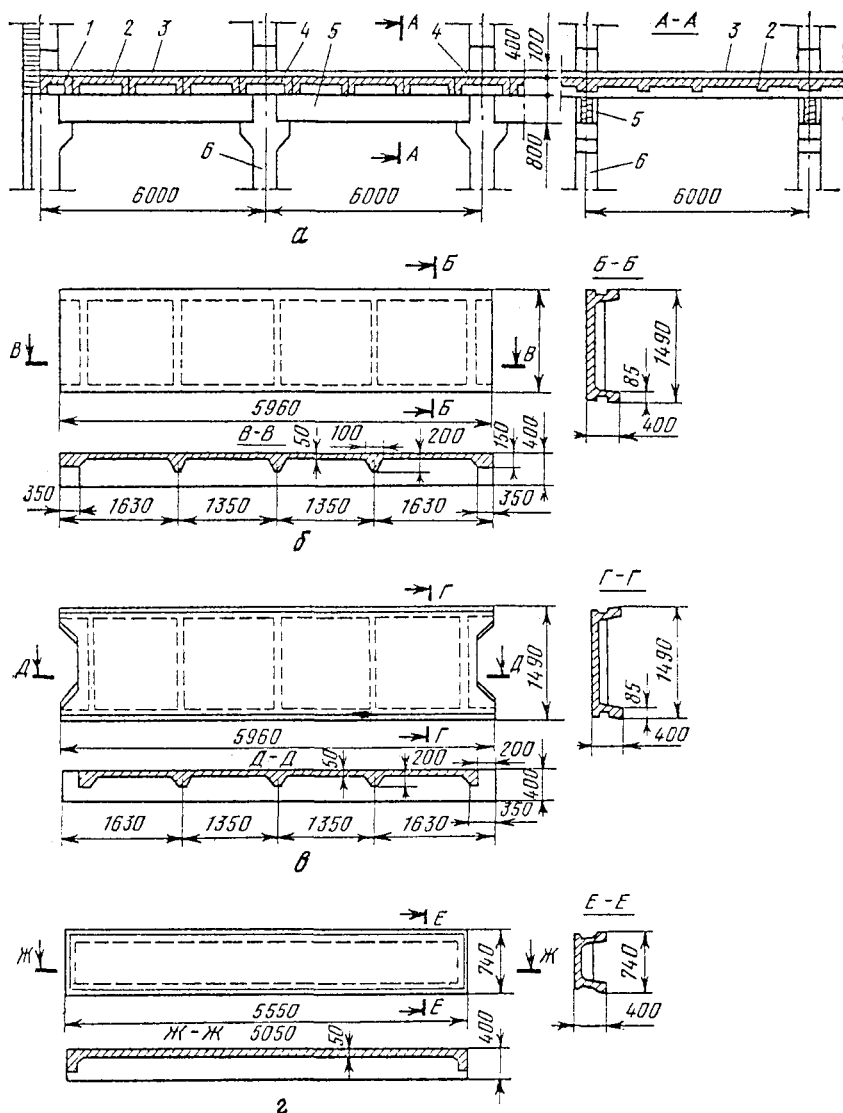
Детали конструкции сборного железобетонного перекрытия:
